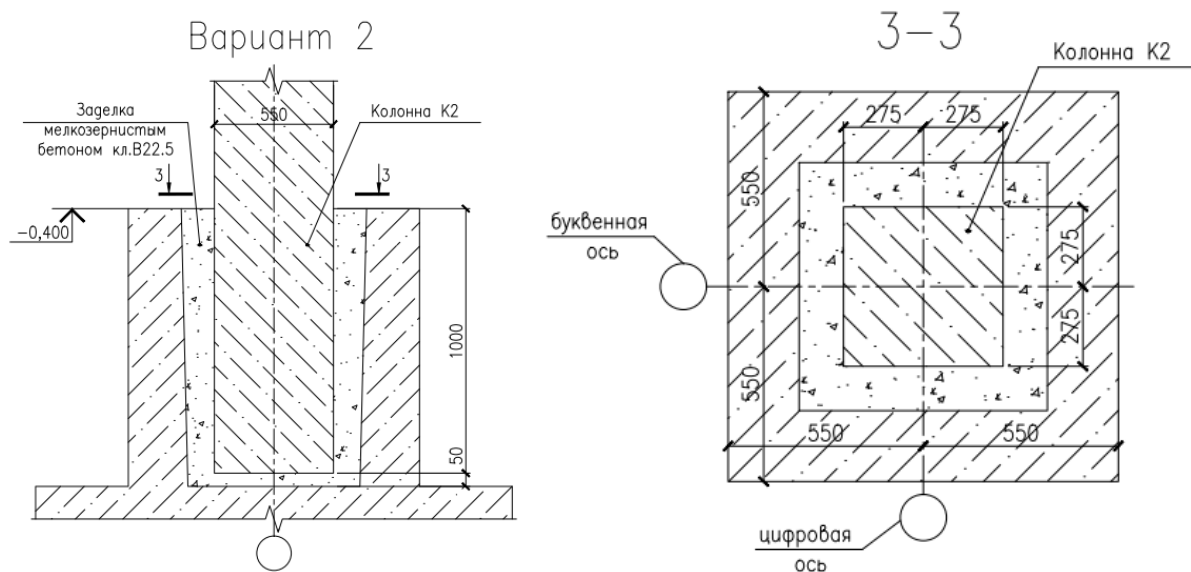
Железобетонная колонна К2 сечением 550х550 и глубиной заделки в стакан фундамента на 1000 мм.
